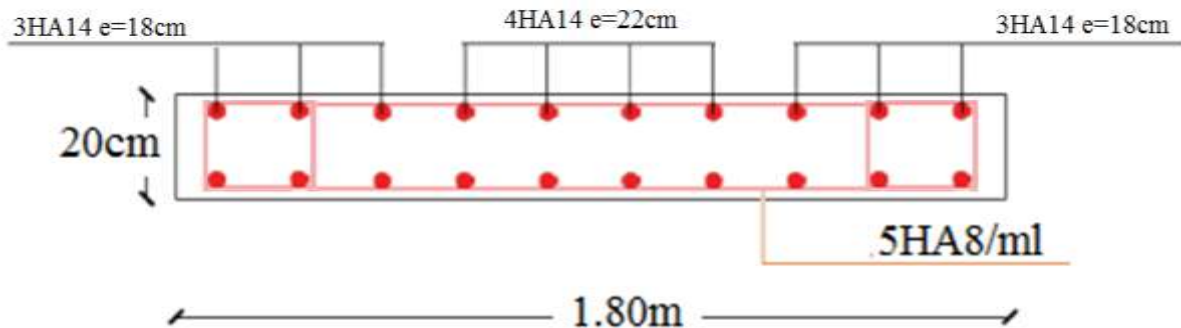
Schéma de ferrailage du voile Vy3(Entresol).
